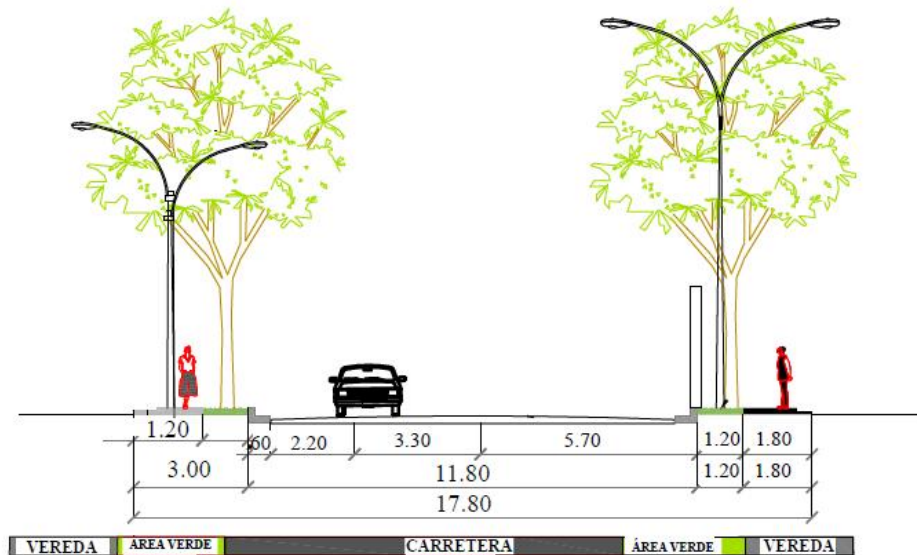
Sección del estado actual y como debería ser planificada la carretera a un espacio o equipamiento deportivo.
